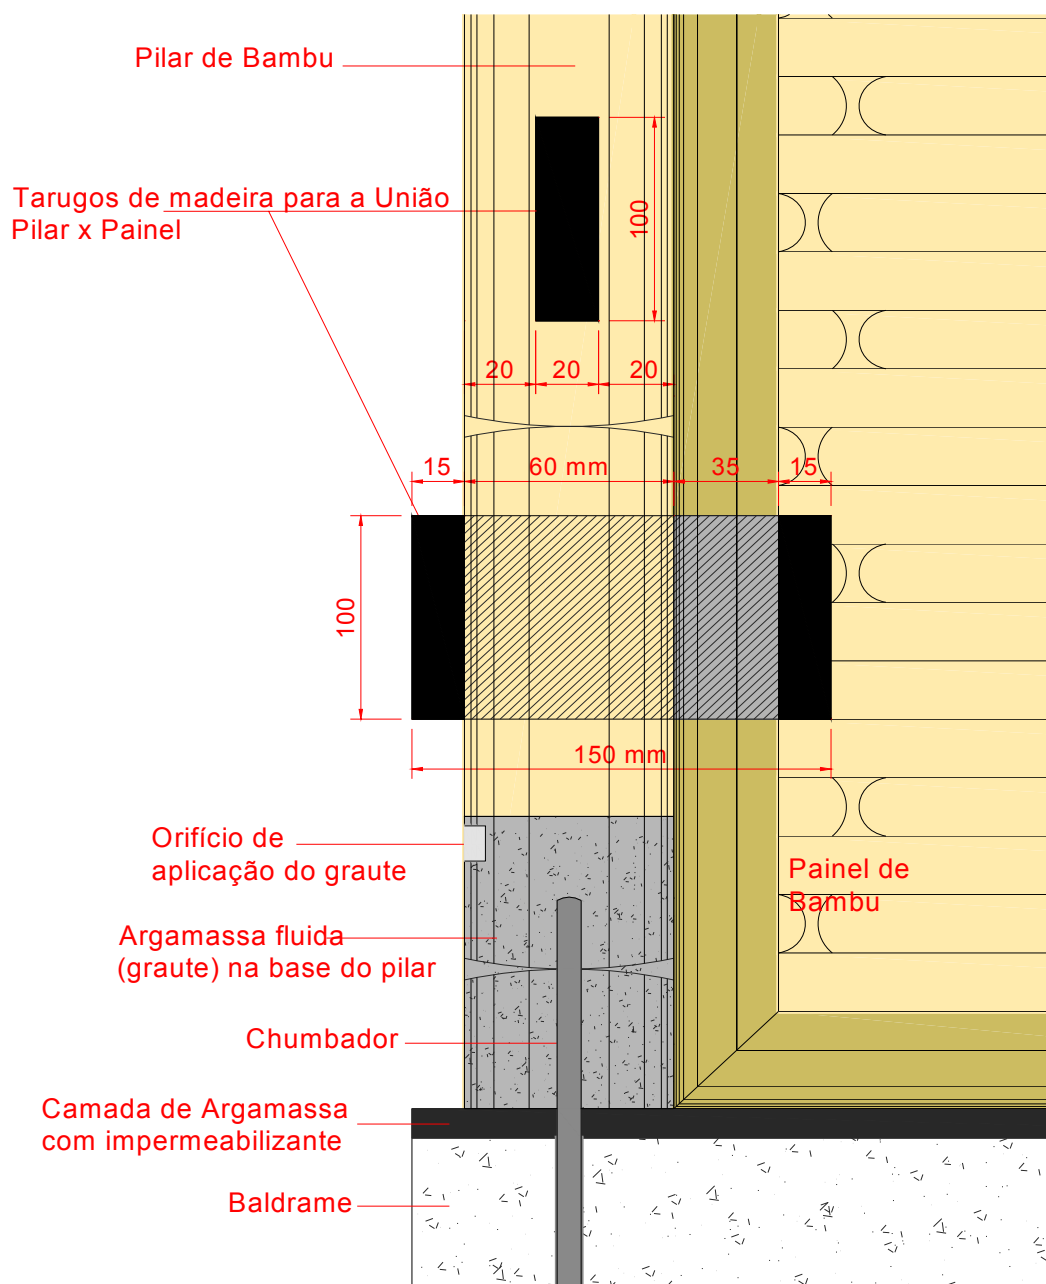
Detalhe da união do painel ao pilar de bambu.
